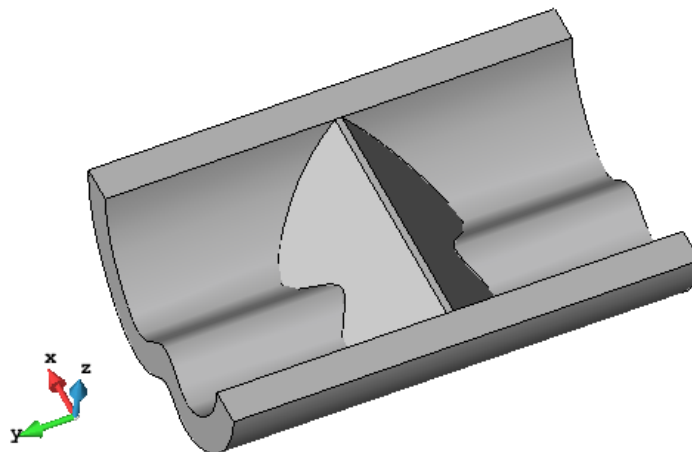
Vista plana de la geometría de la presa intersecada con el terreno
